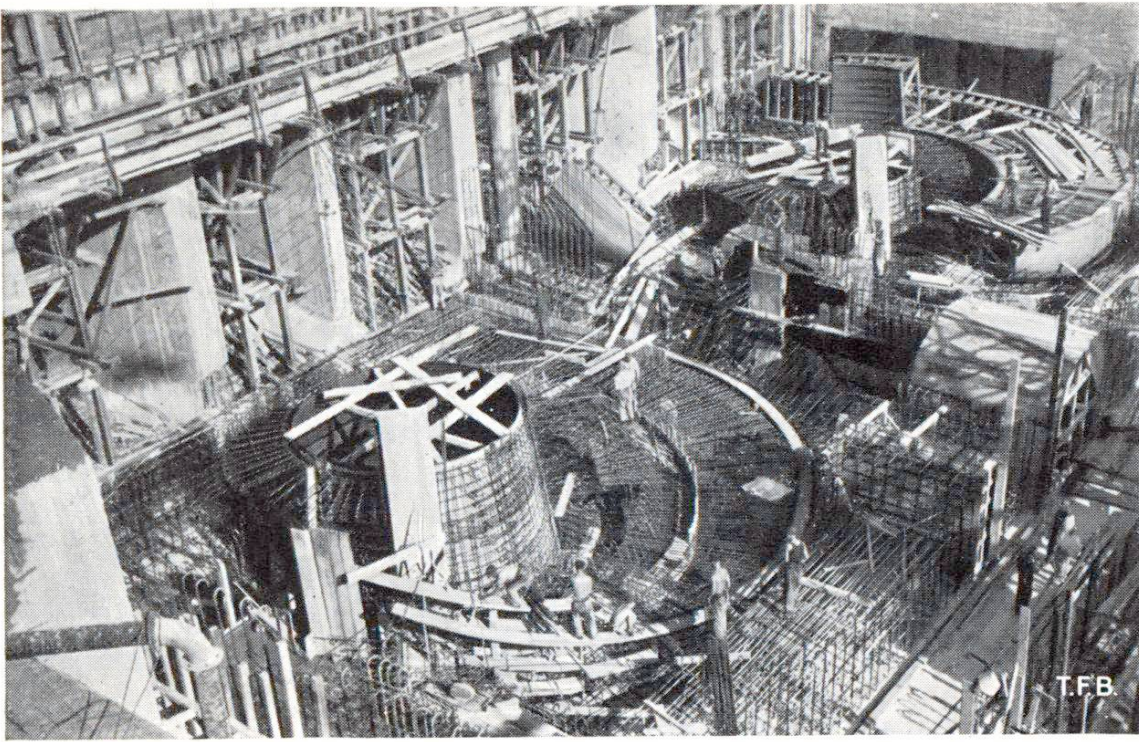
Au premier plan: Armature de la semelle d'une bache spirale
